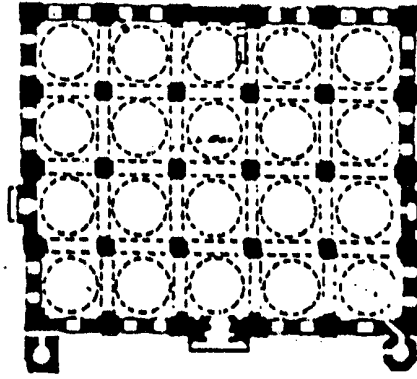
مسقط أفقي لجامع محمود بطرابلس الغرب
